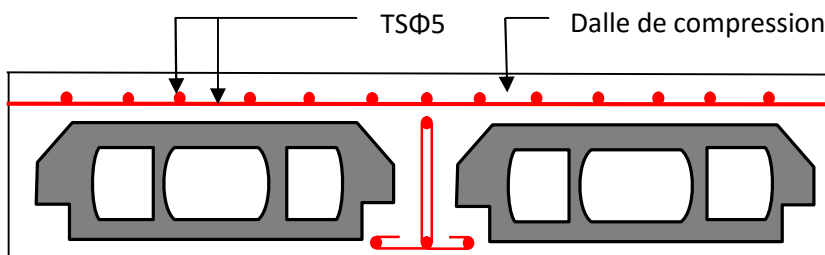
Schéma de ferrailage de la dalle de compression.
